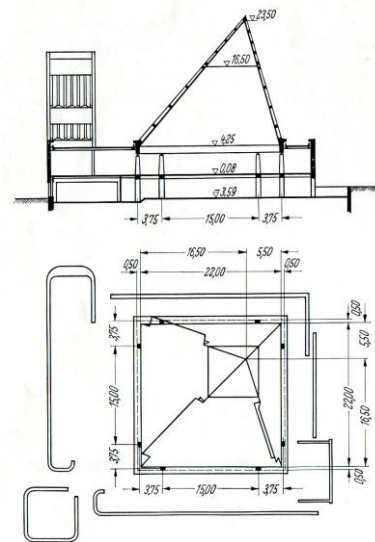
Pfarrkirche St. Andreas, Grundriß und Schnitt.
